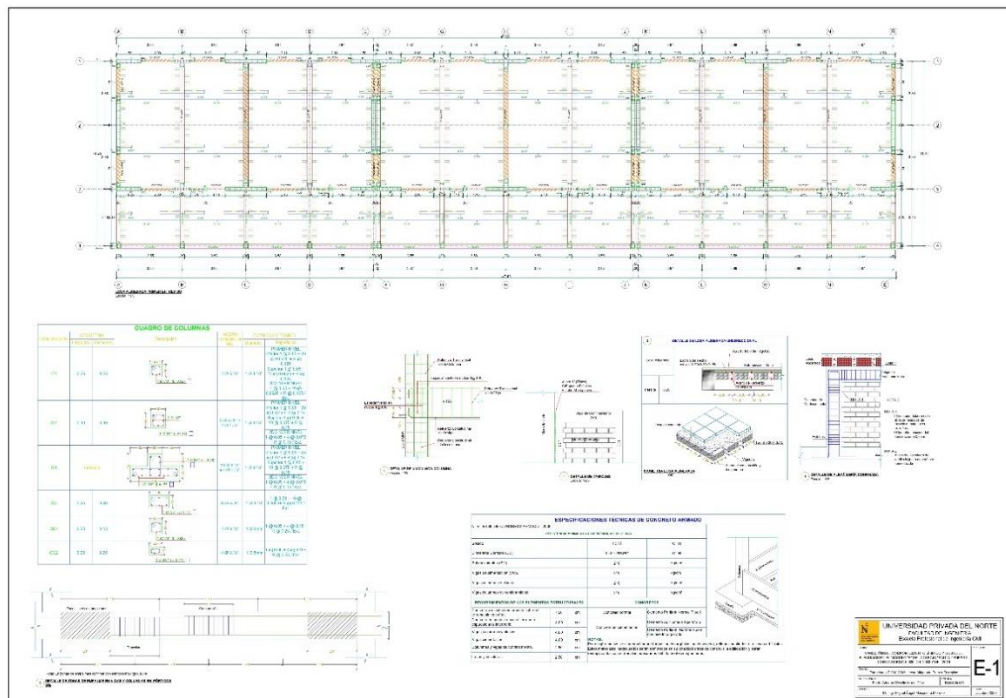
Plano estructural – Losa aligerada primer entrespacio.
